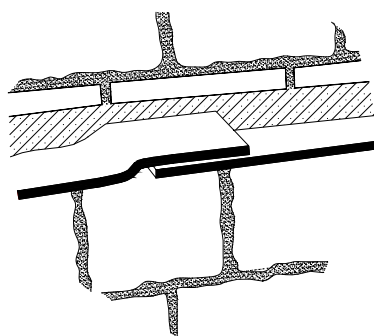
Pormenor das camadas sobrepostas [52]
